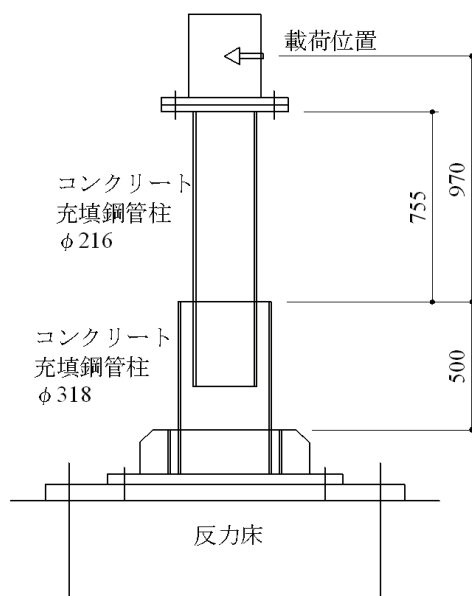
コンクリート充填ソケット接合部試験体 (単位 mm)⁵²⁾
